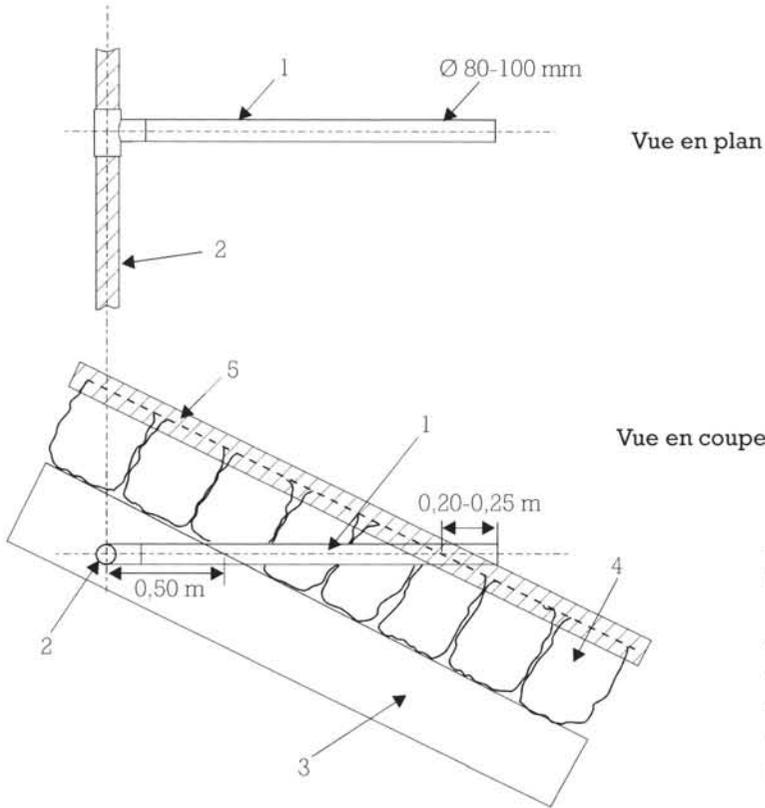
Schéma de principe d'un éjecteur (d'après [3])
